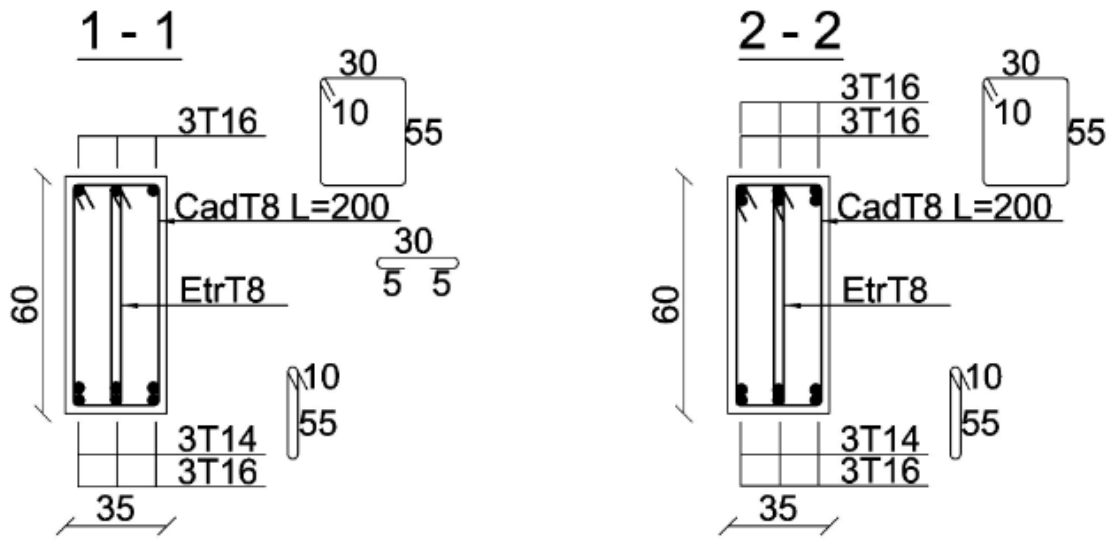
Schéma de ferrailage des poutres (35x60).
